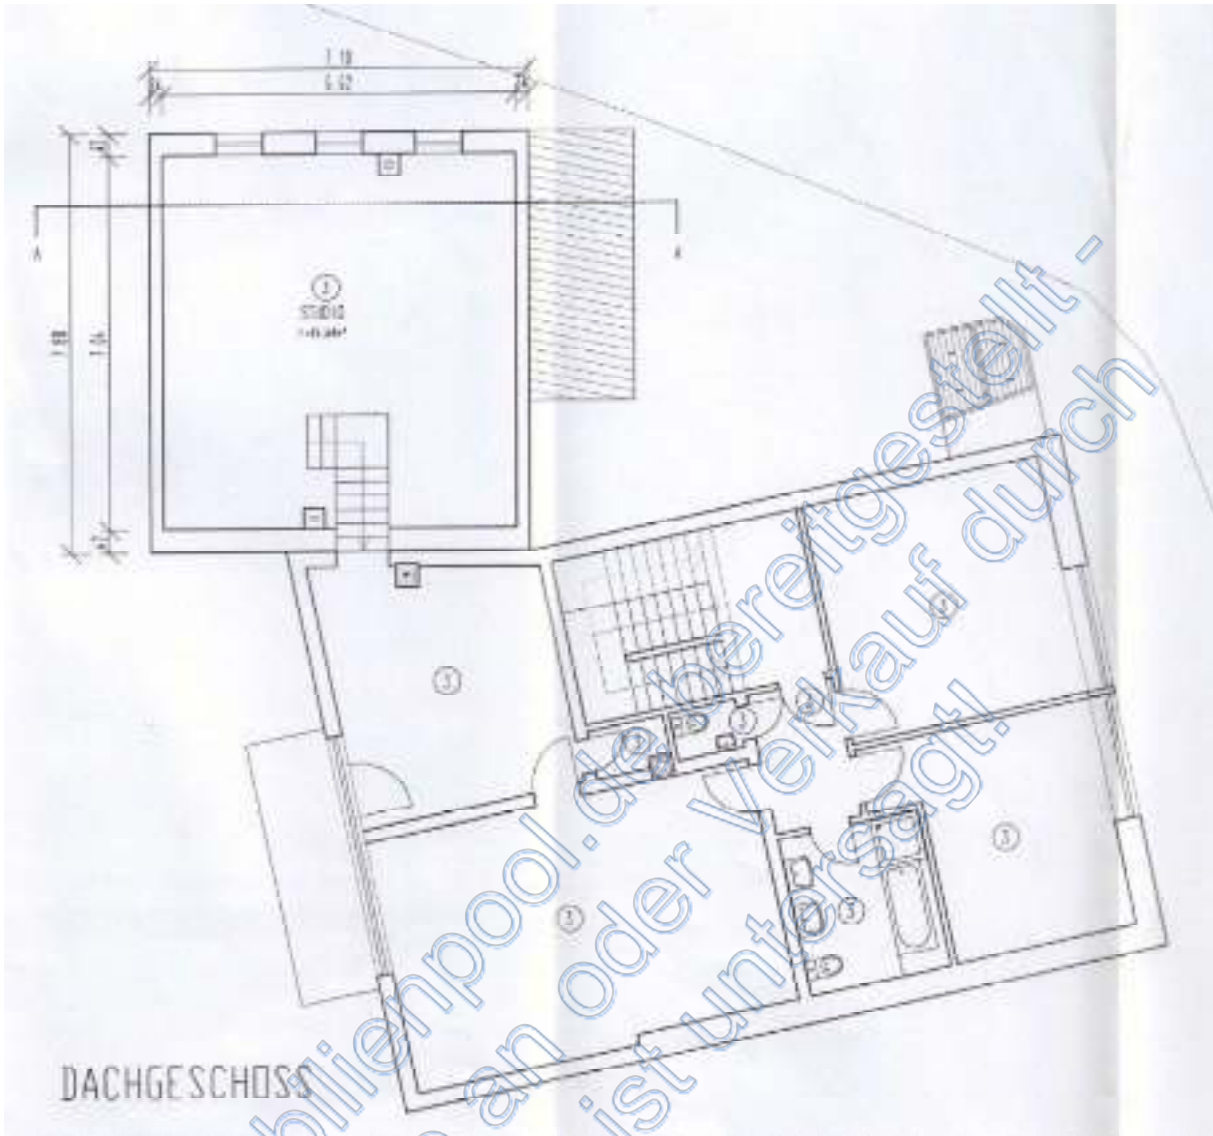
Studio im Dachgeschoss des Altbaus mit Anschluss an die Dachgeschosswohnung des Neubaus (ohne Maßstab)
